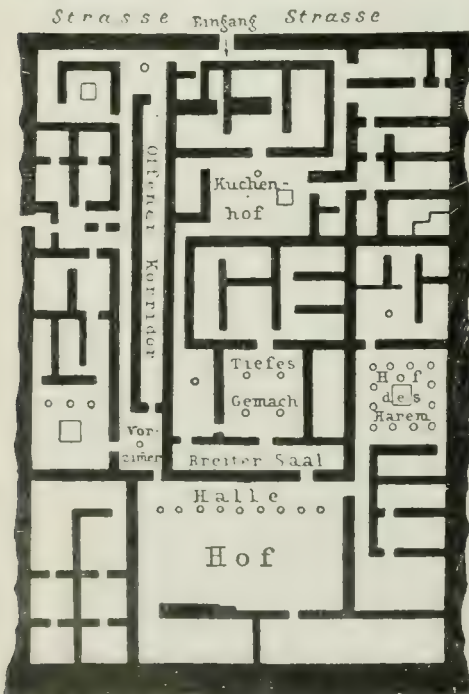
Grundriss eines ägyptischen Wohnhauses (s. S. 20).
